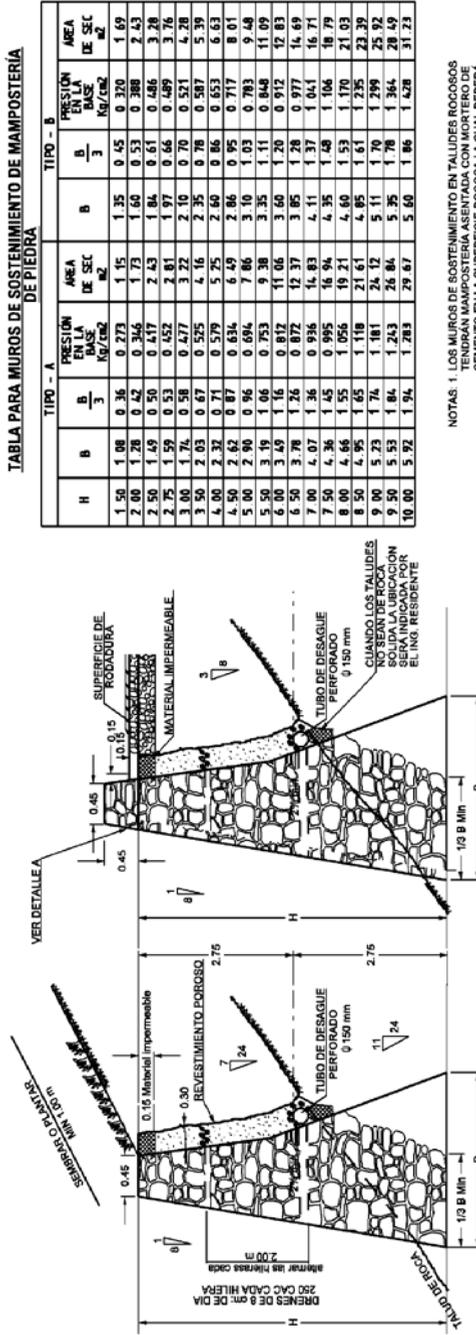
Muro de sostenimiento de mampostería de piedra
